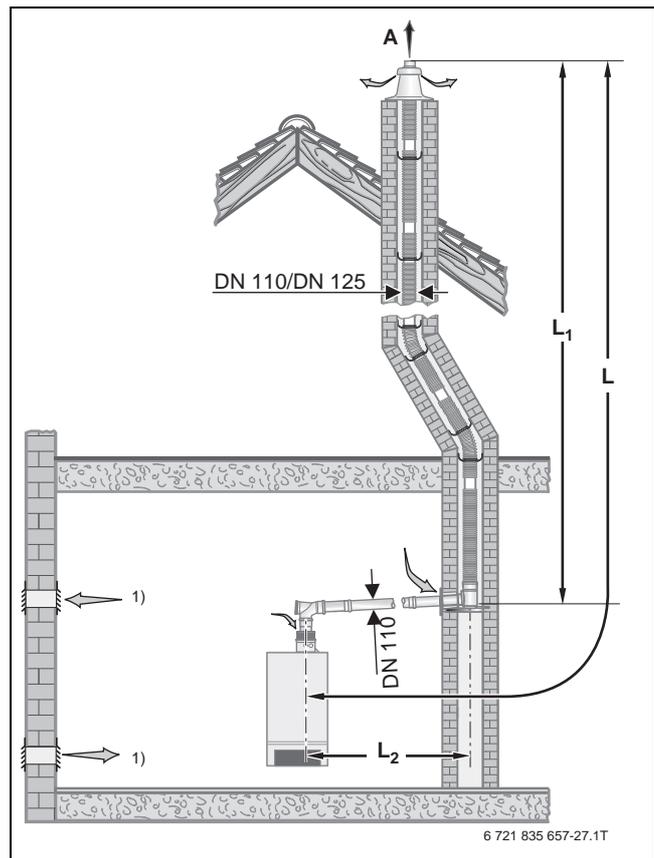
Montagevariante im Schacht mit dem Bausatz GA + ÜB-Flex
